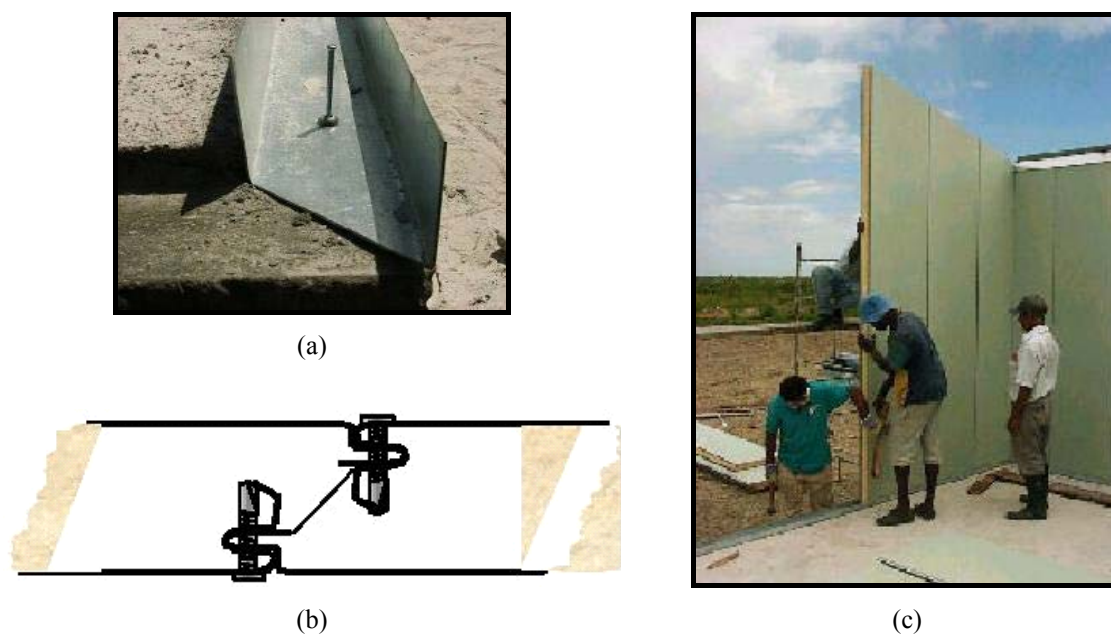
Montagem de casa da *Daedalus Systems*: (a) fixação da canaleta à fundação; (b) ligação entre painéis; (c) montagem das paredes de painéis.
